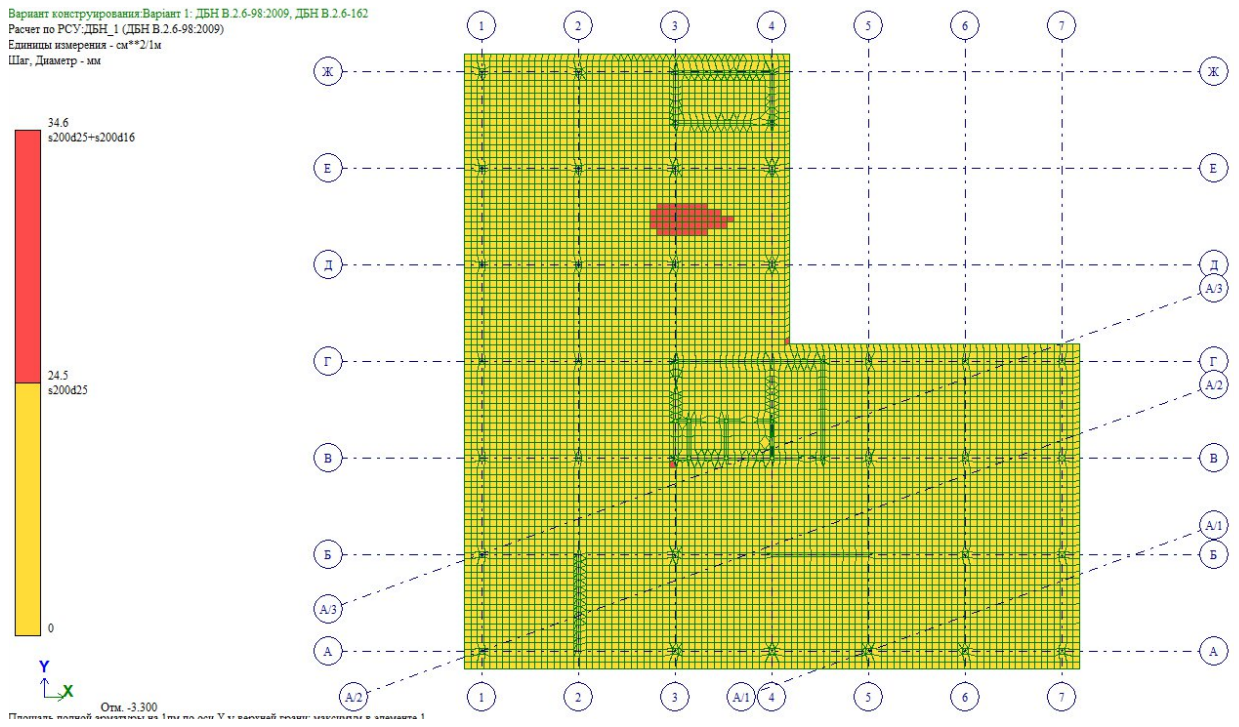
Площа арматури на 1пм біля верхньої грані по осі У
